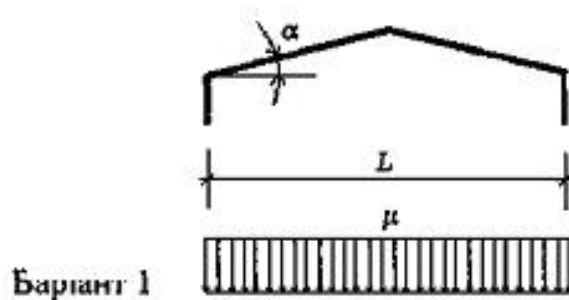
Схема снігового навантаження для заданої будівлі
